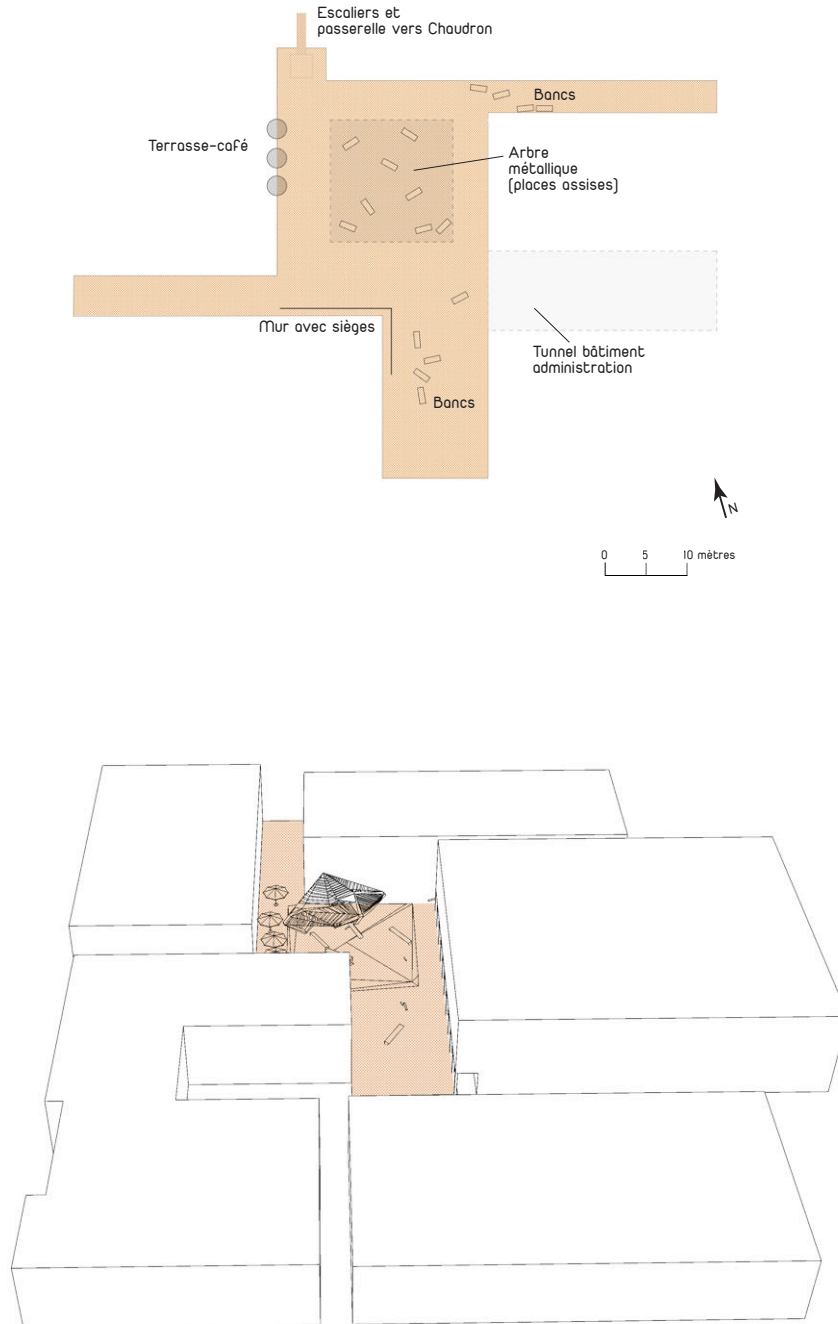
Plan de site et vue 3D de la Place Flon-Ville (Source : Ian Losa)
